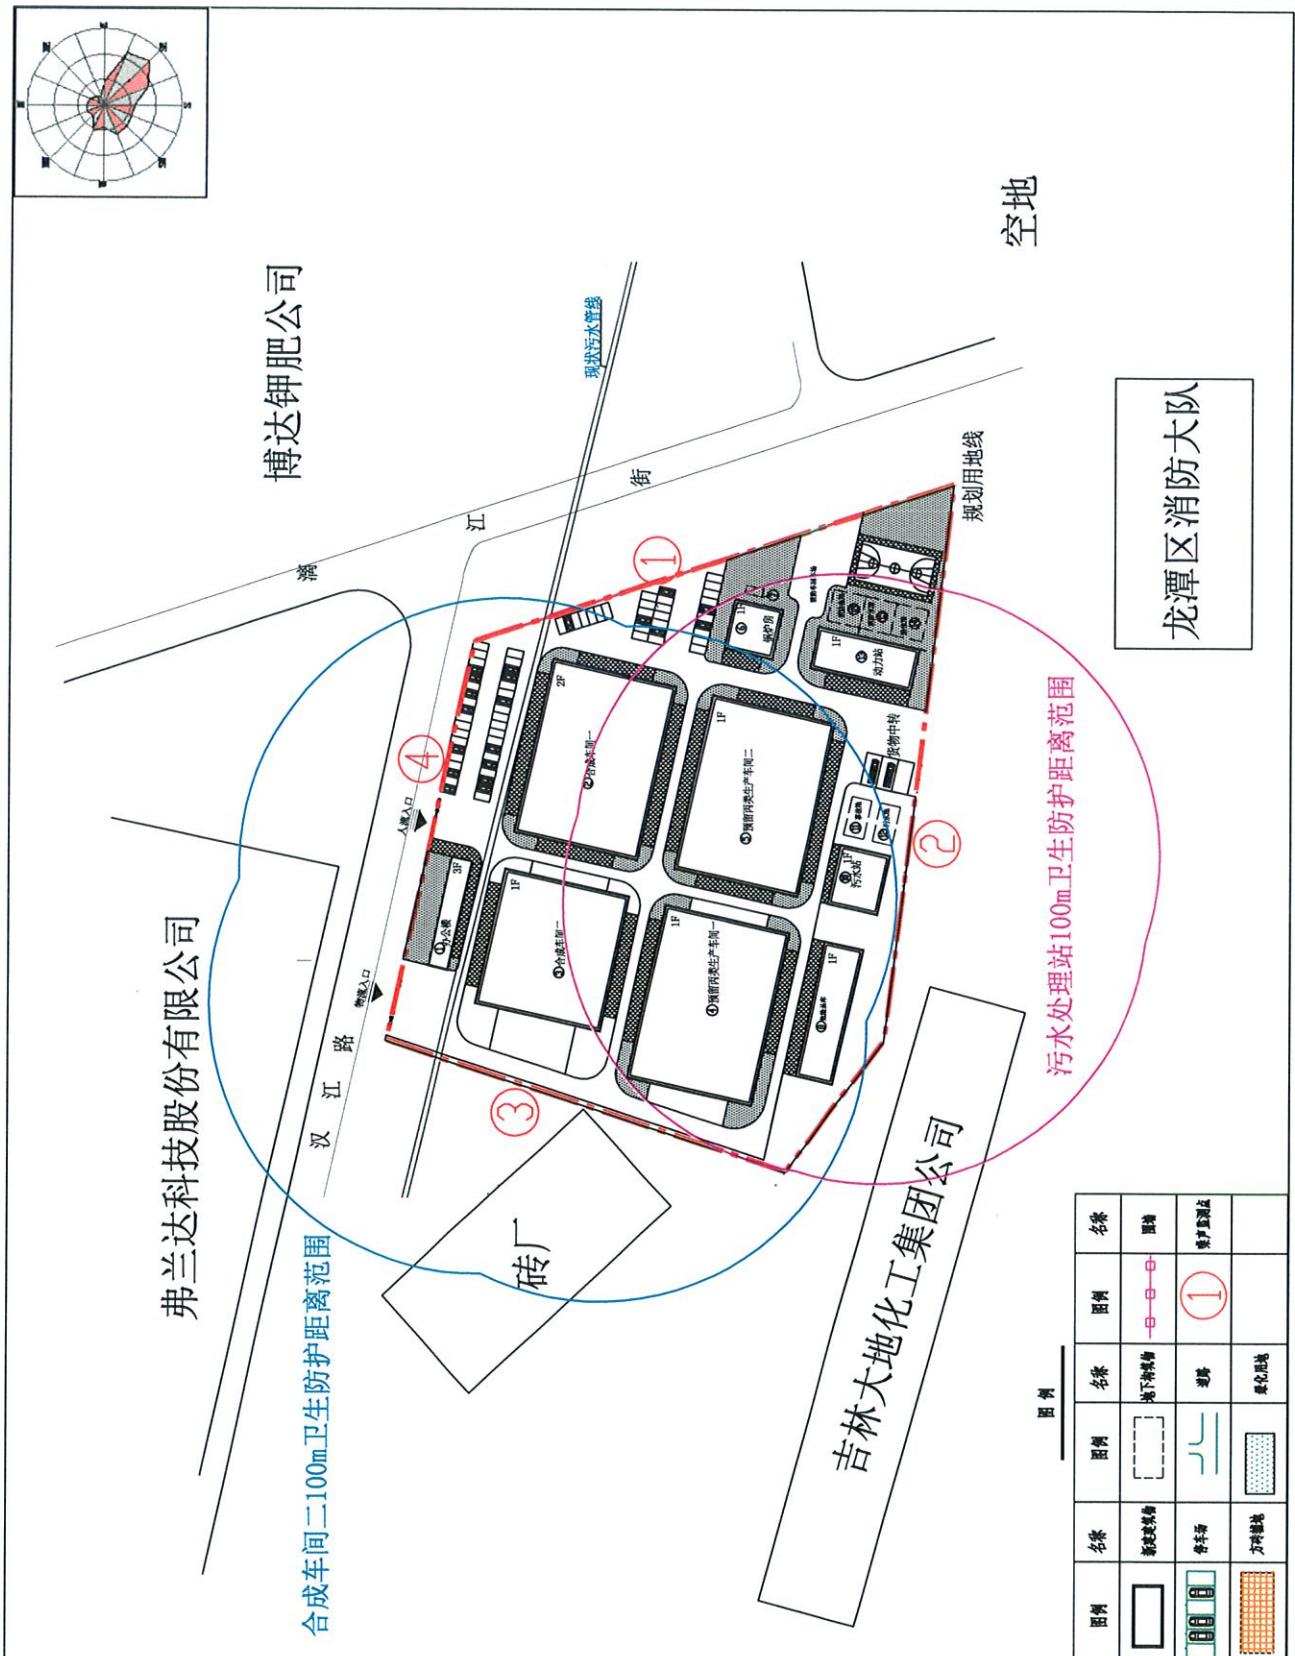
厂区平面布置、周围环境敏感点及噪声监测点位、卫生防护距离范围示意图
